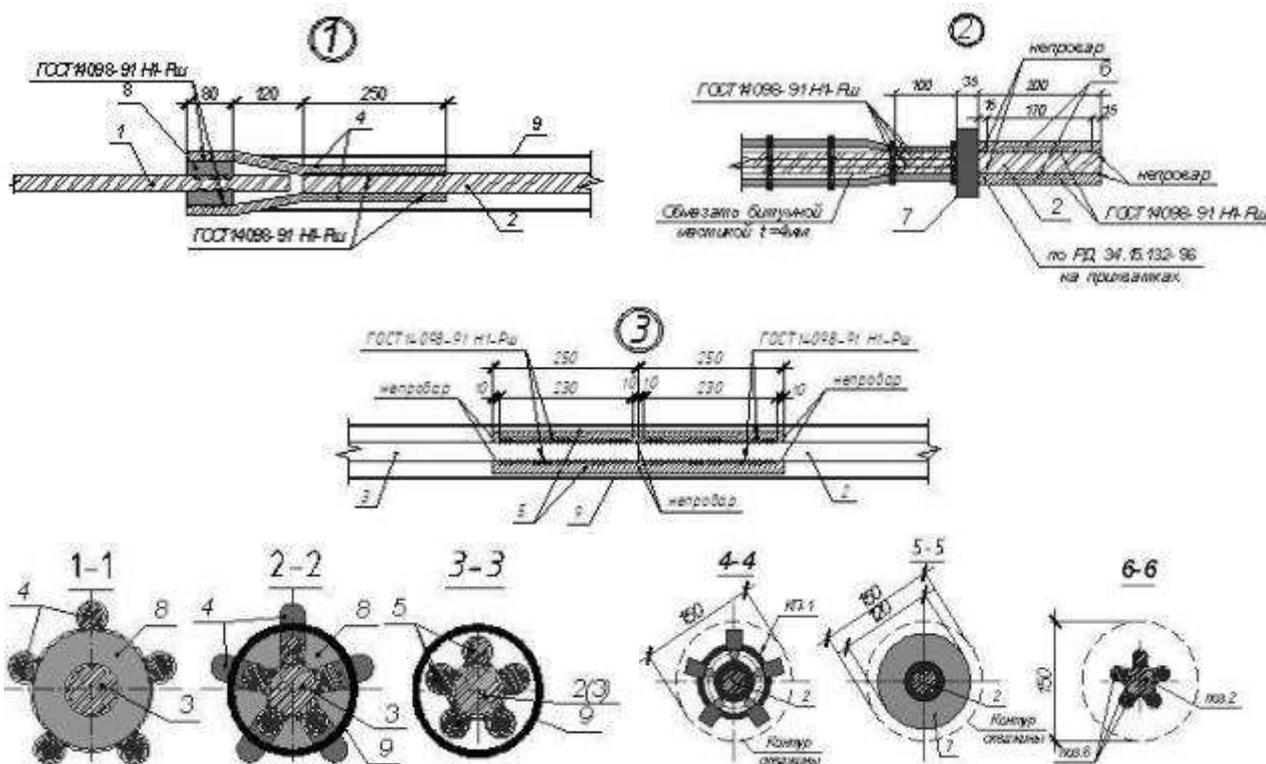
Узлы и разрезы к схеме грунтового анкера АГп-24/10 (рис. 4):
